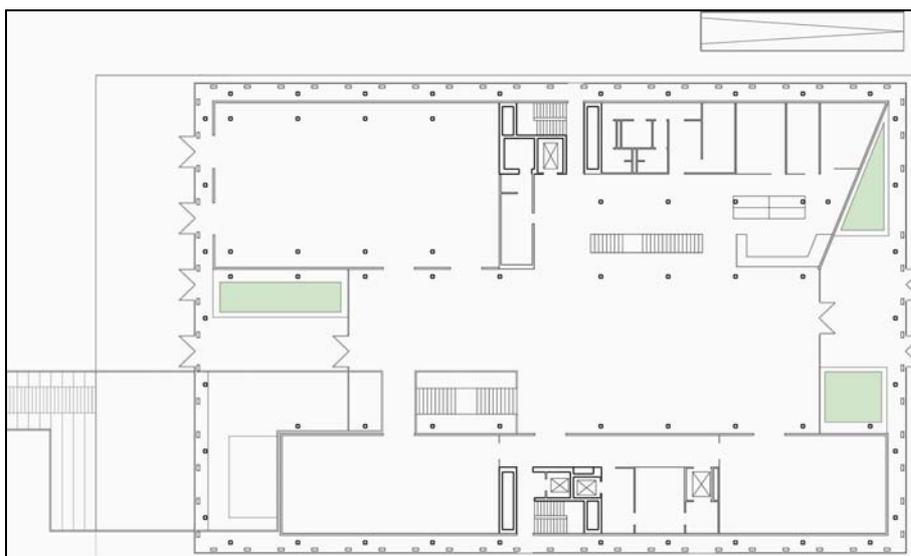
Grundriss der Landesvertretung NRW in Berlin
